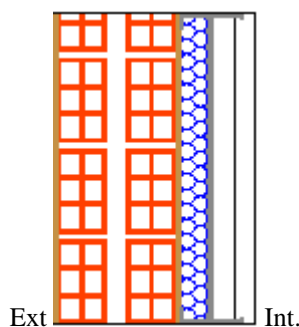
Solução Fach. 7 - Execução de uma contrafachada pelo interior em gesso
